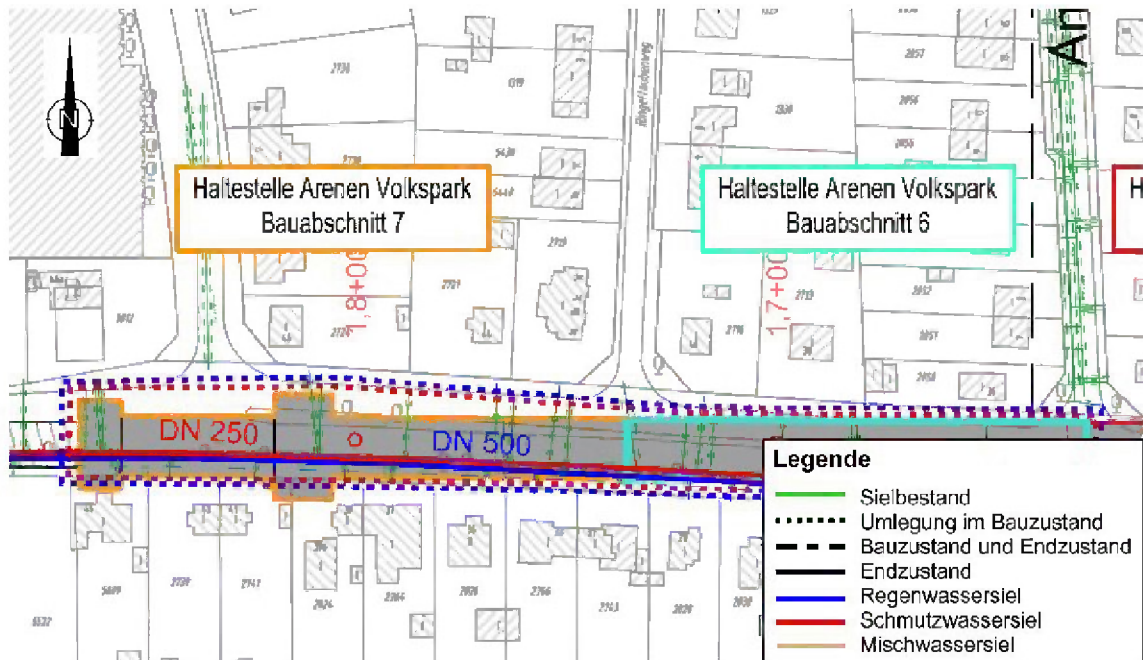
Sielplan Baubereich Arenen Volkspark, Bauabschnitt 6+7 (Stand: 04.2019)
